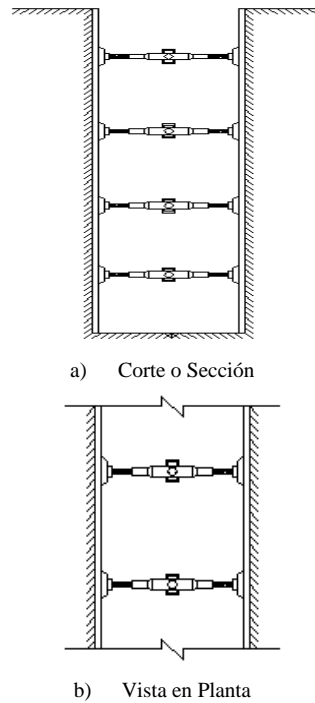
a) Vista en perfil de la entibación y b) Vista en planta de la entibación
